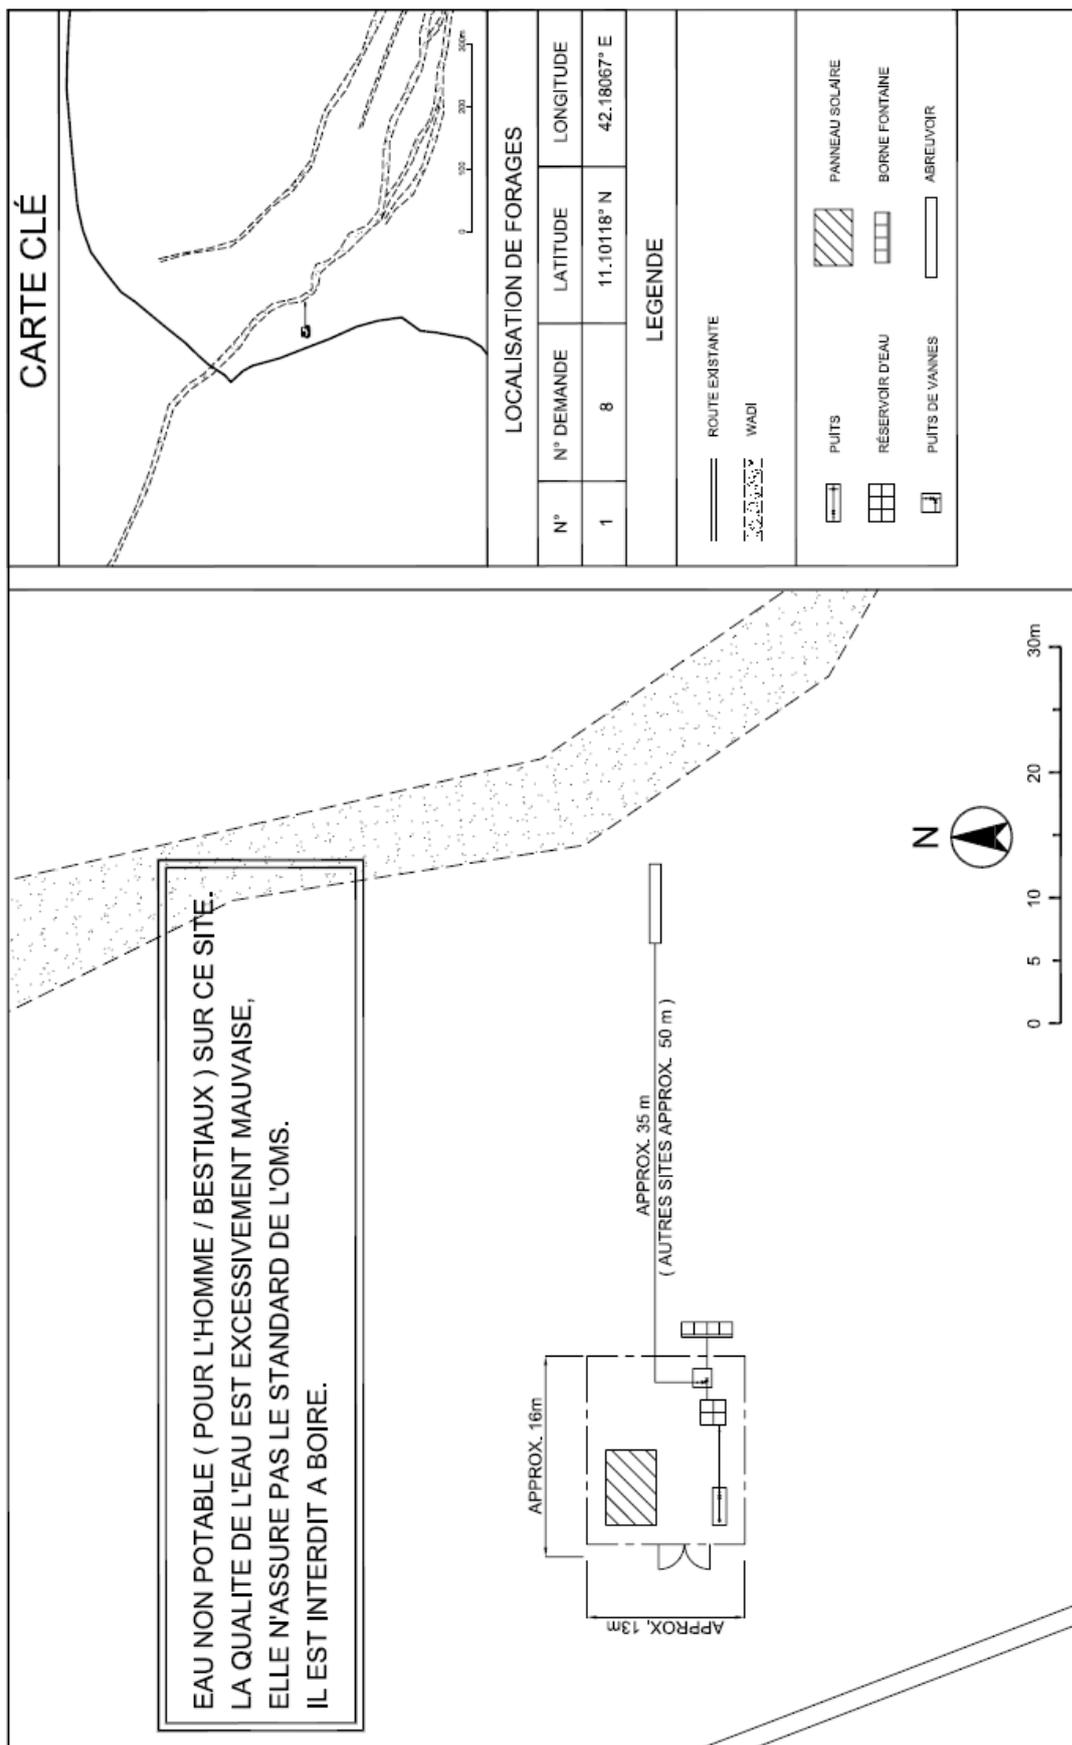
Plan d'implantation des installations (iii) [Zina Male]
